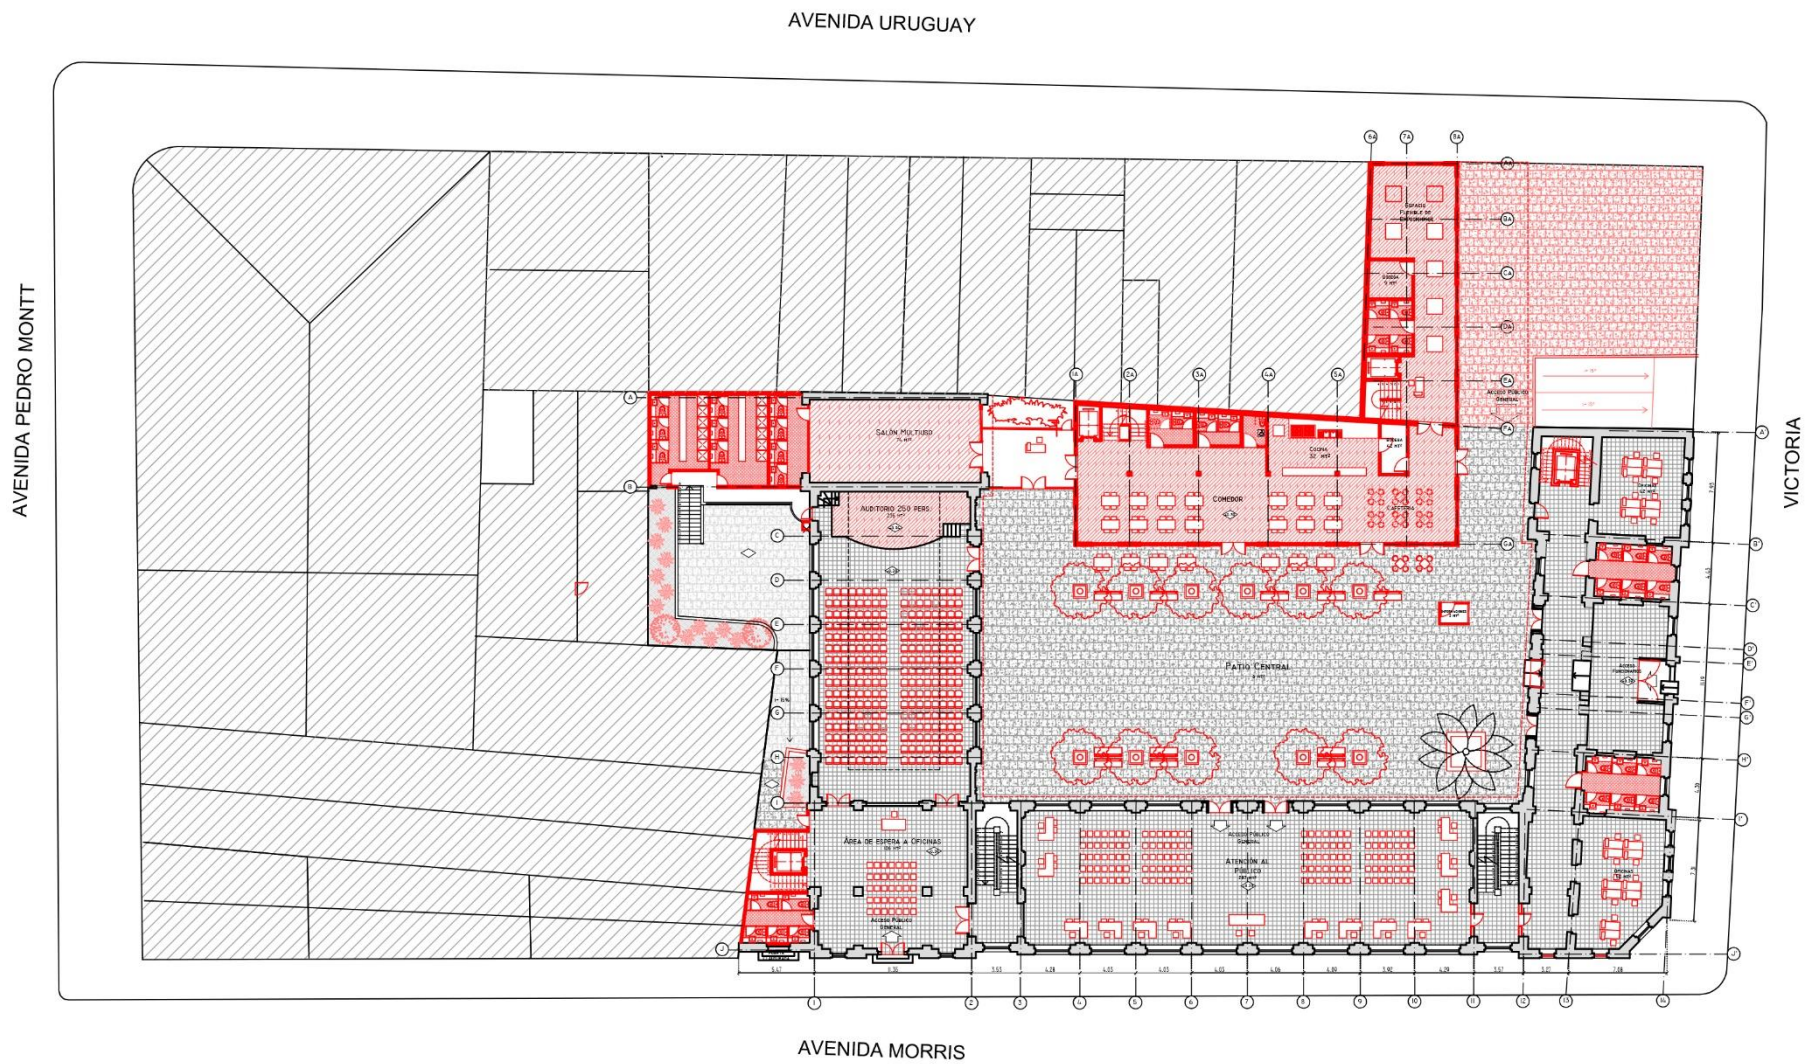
Planta de Propuesta Primer Nivel. Fuente: Elaboración Propia,.
